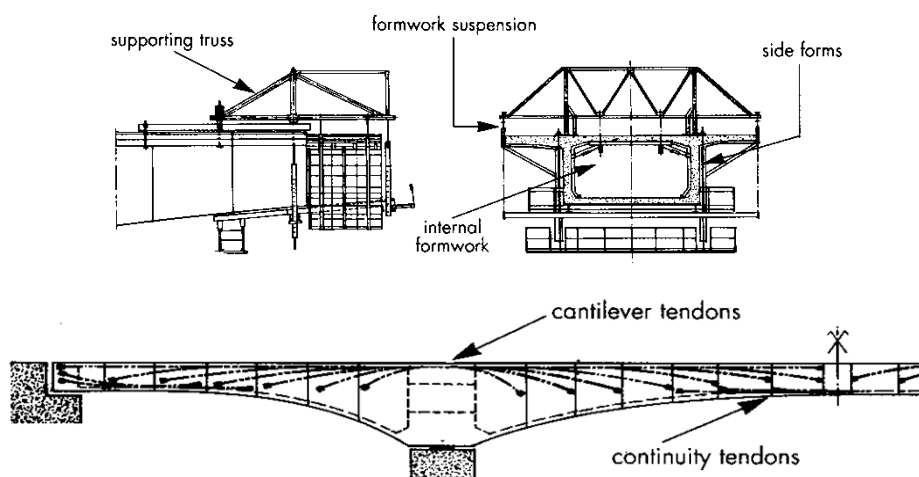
, 118 e 119: Esquema de aplicação de cofragem e respectivos pontos de apoio e sistema de aplicação de pré-esforço
